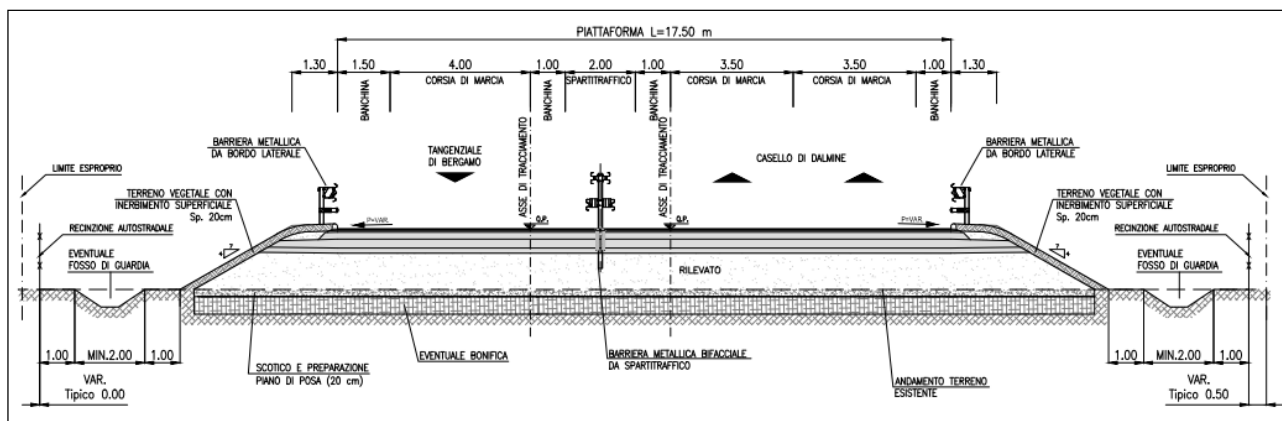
Sezione tipo rampa bidirezionale a 3 corsie
